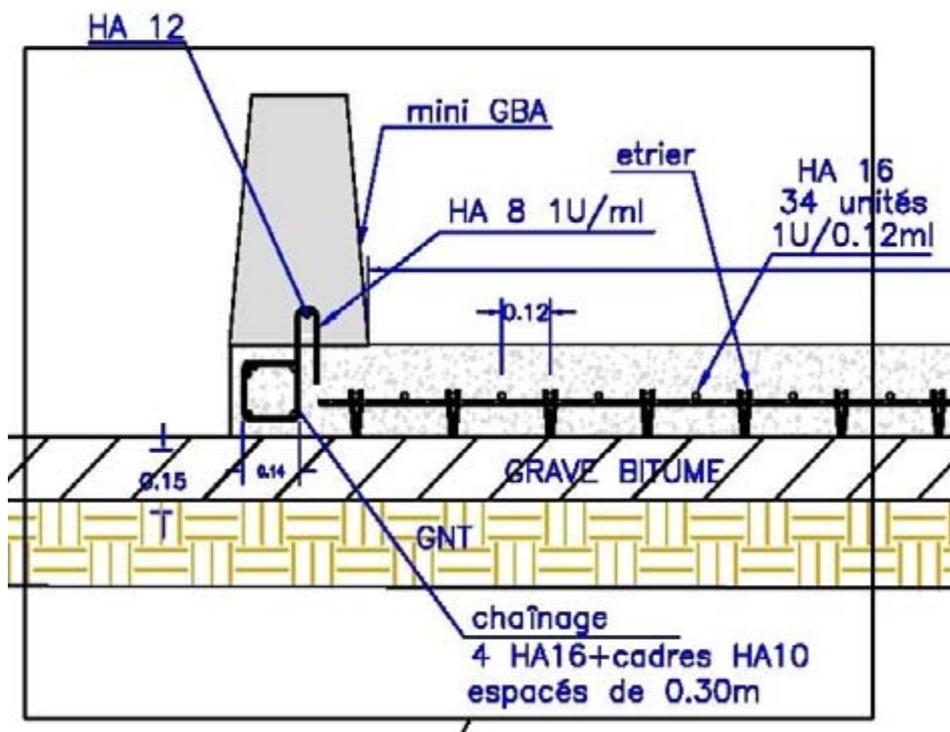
Exemple de chaînage et d'attente pour muret en béton coulé en place
